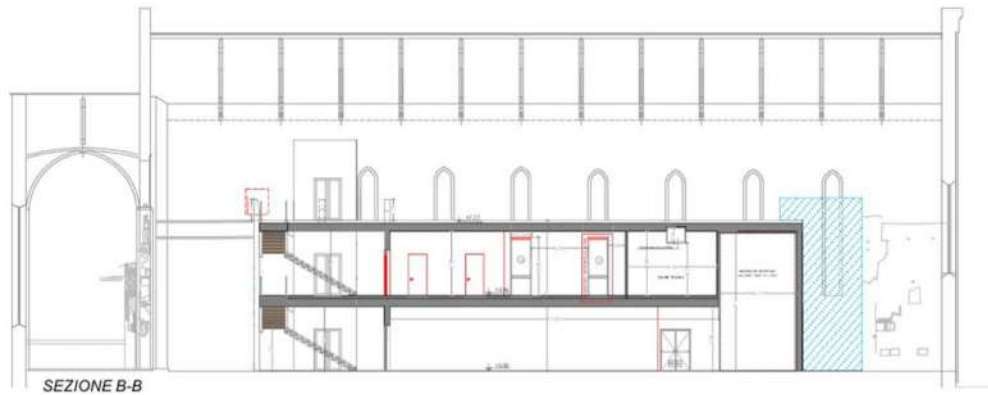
sezione longitudinale della Chiesa con l'inserimento del volume della nuova struttura.
